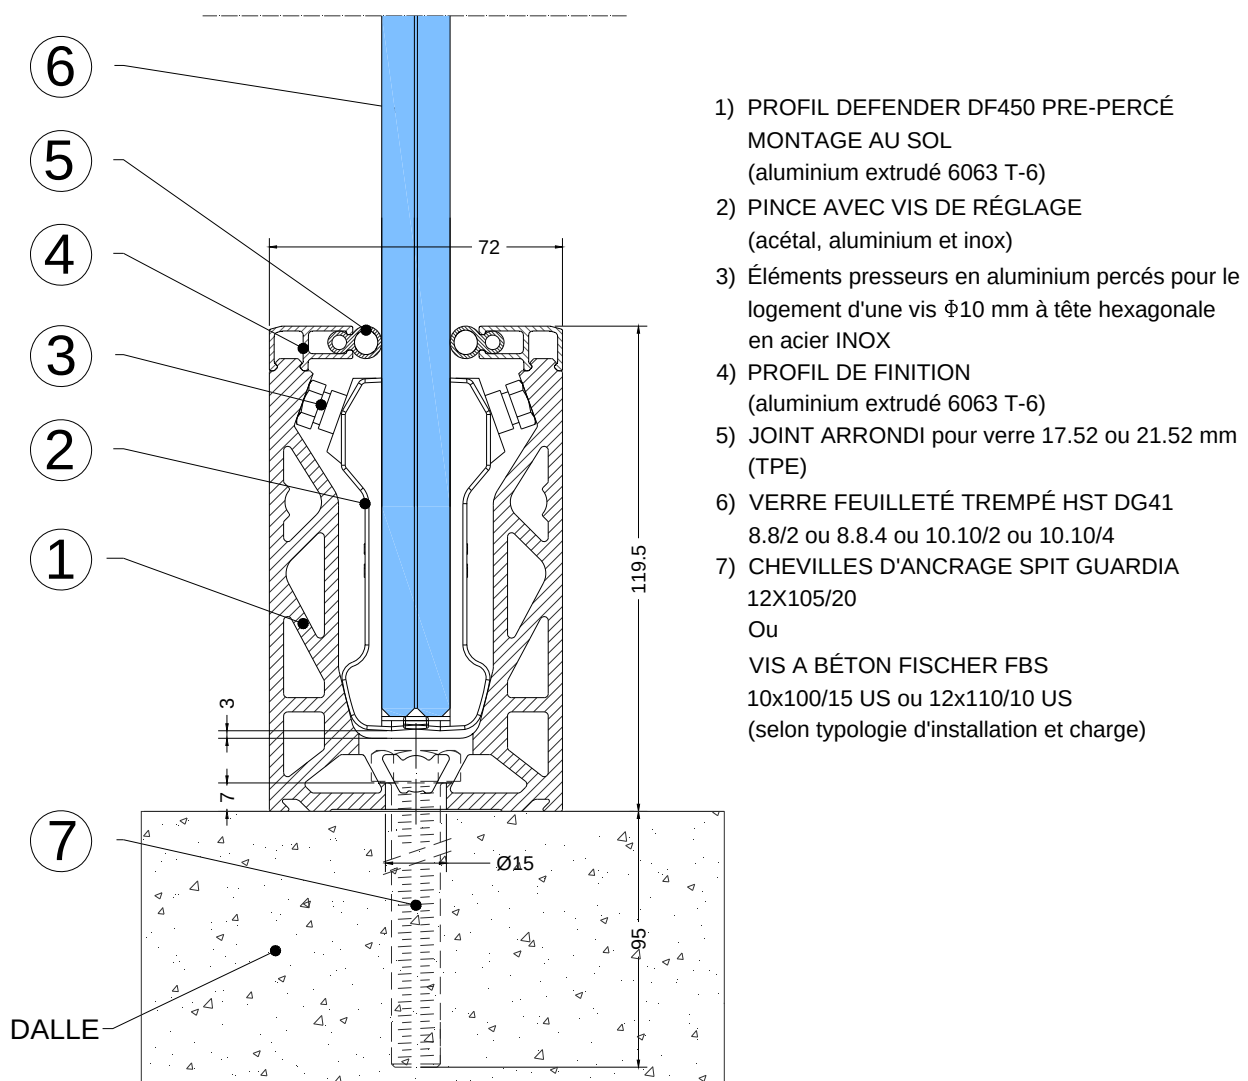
Fender Glass / DEFENDER-DF450 – Montage sur dalle
